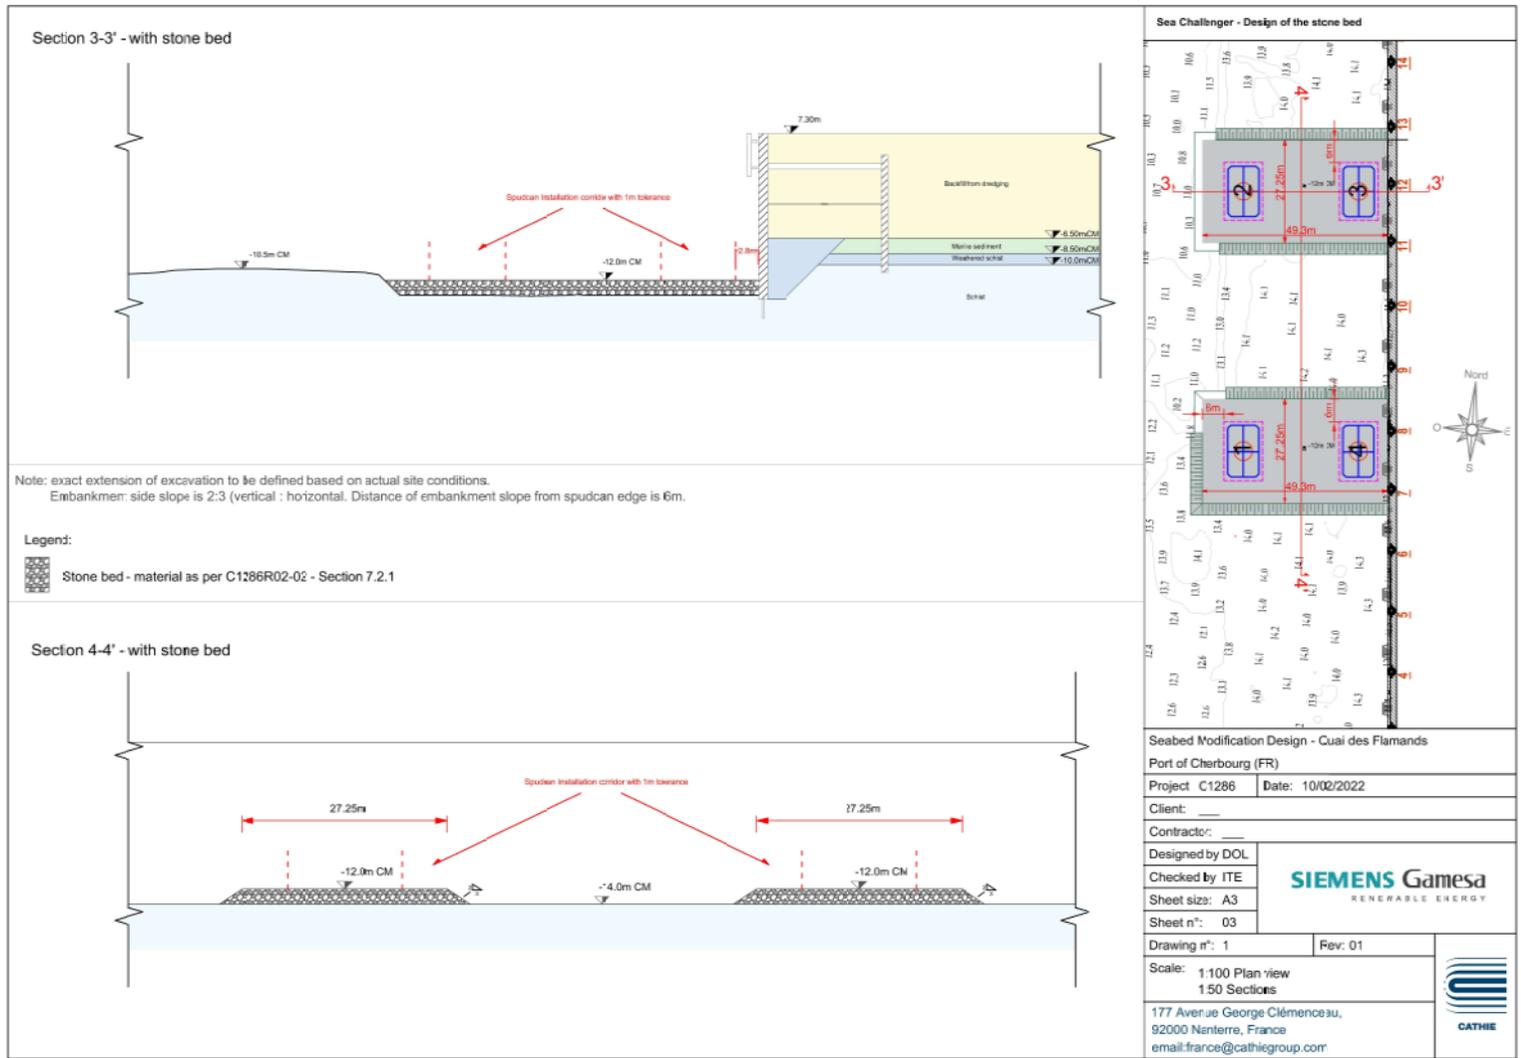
Plan d'implantation du lit de graviers installé par SGRE (source : SGRE 02/2022)
